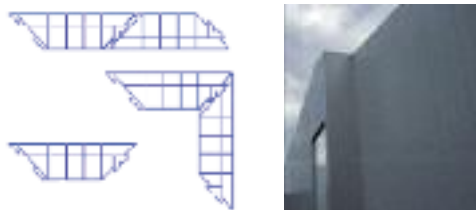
Construção em painéis de PVC: a) Esquema do perfil; b) Protótipo.
